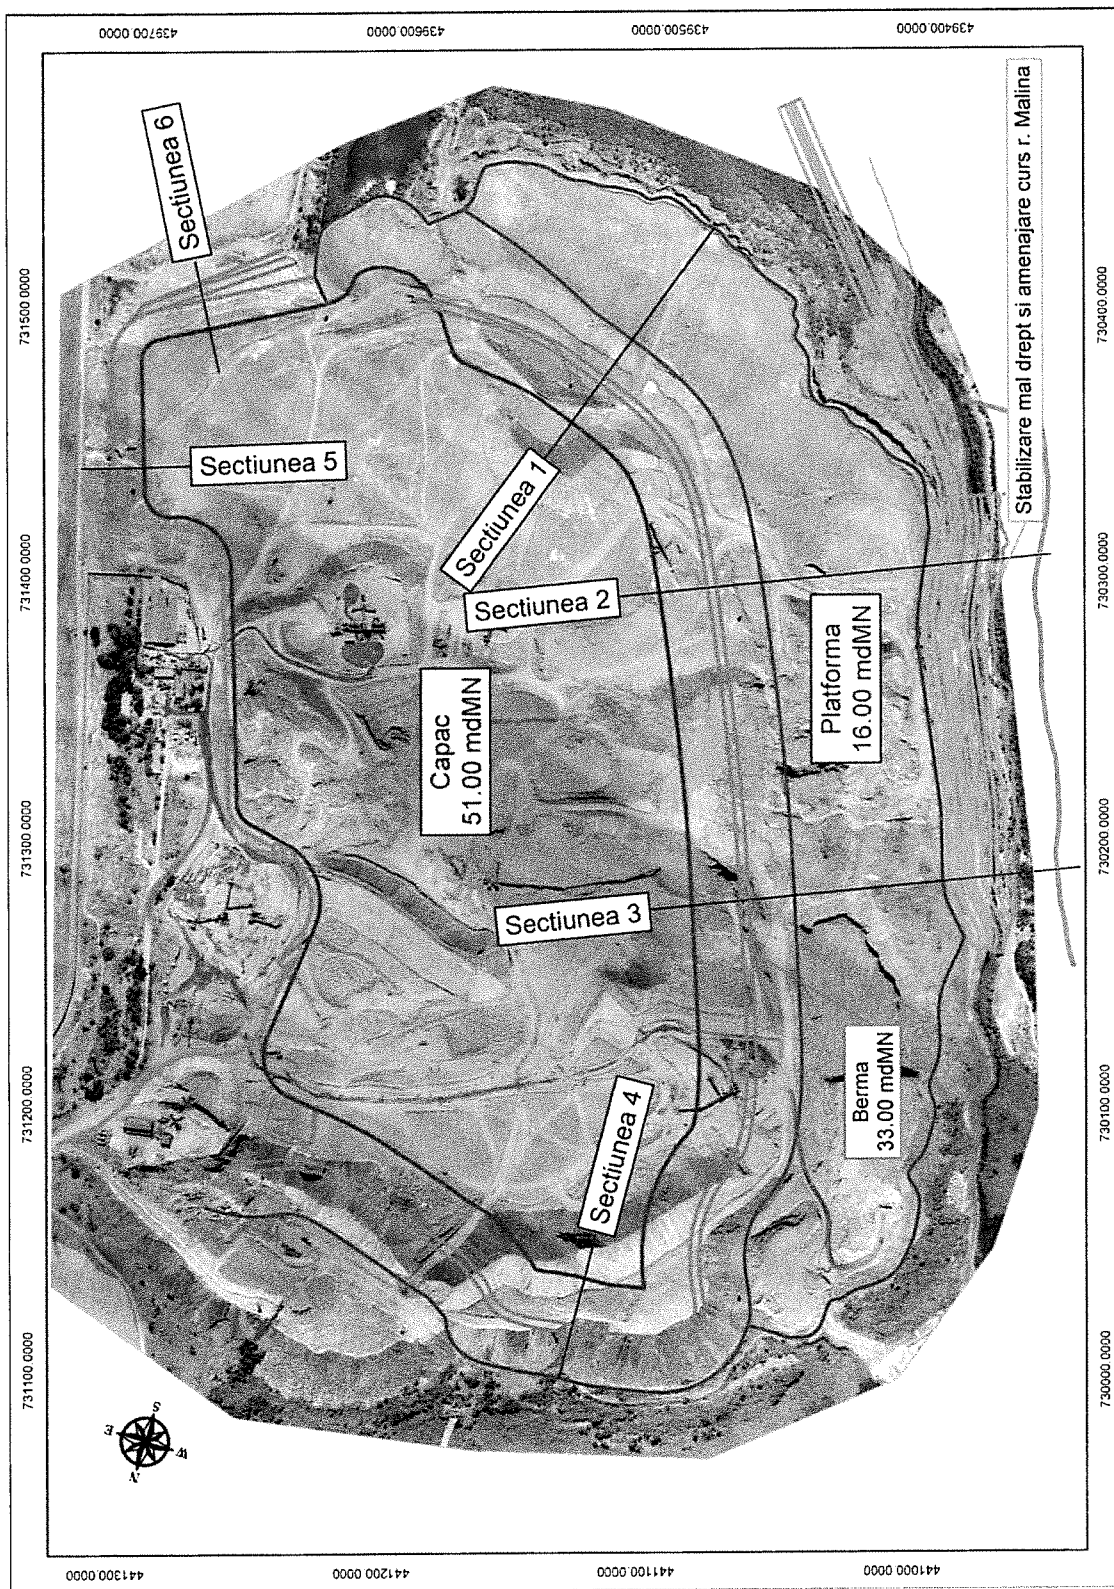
Plan cu precizarea secțiunilor caracteristice (de la 1 la 6))
